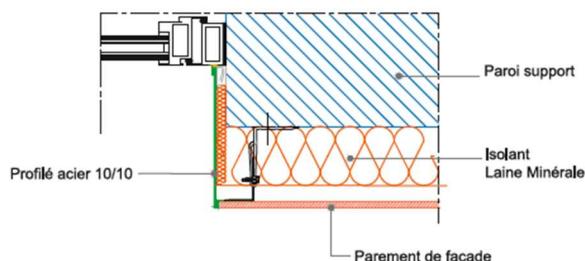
Coupe horizontale encadrement de la baie niveau tableau
